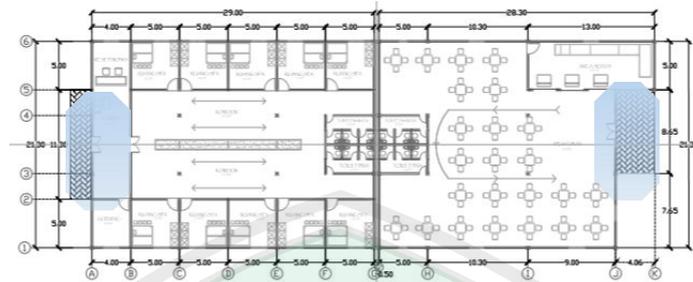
Tampak dan Denah Pengelola Cottage
